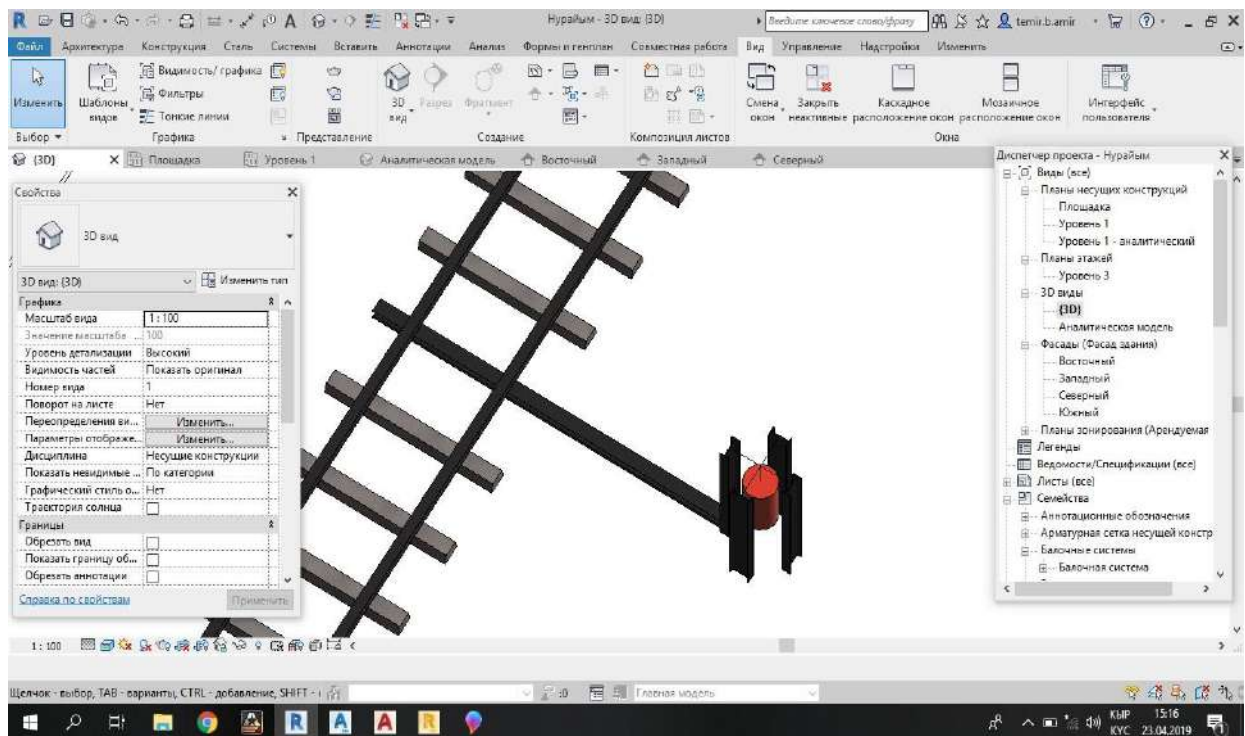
3D вид предлагаемой конструкции в среде Revit, вид сверху
